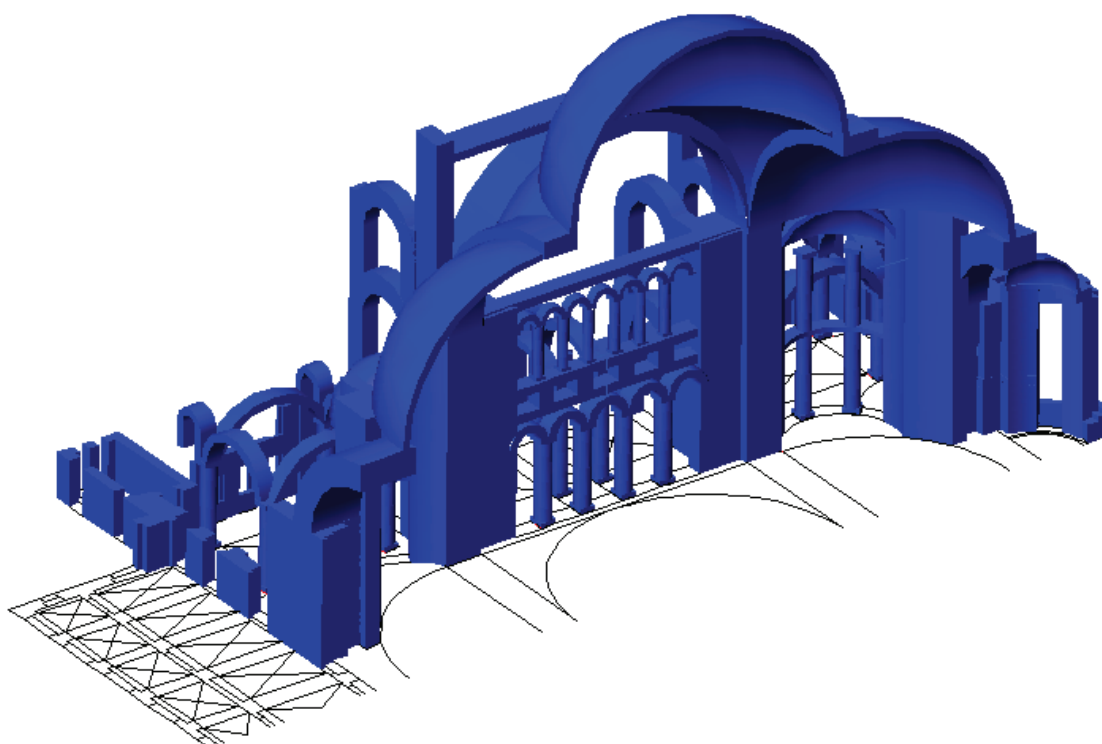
Santa Sofía, sección longitudinal (esquema estructural nave central; agrupamiento de cúpulas). (Construcción 3D del autor)
